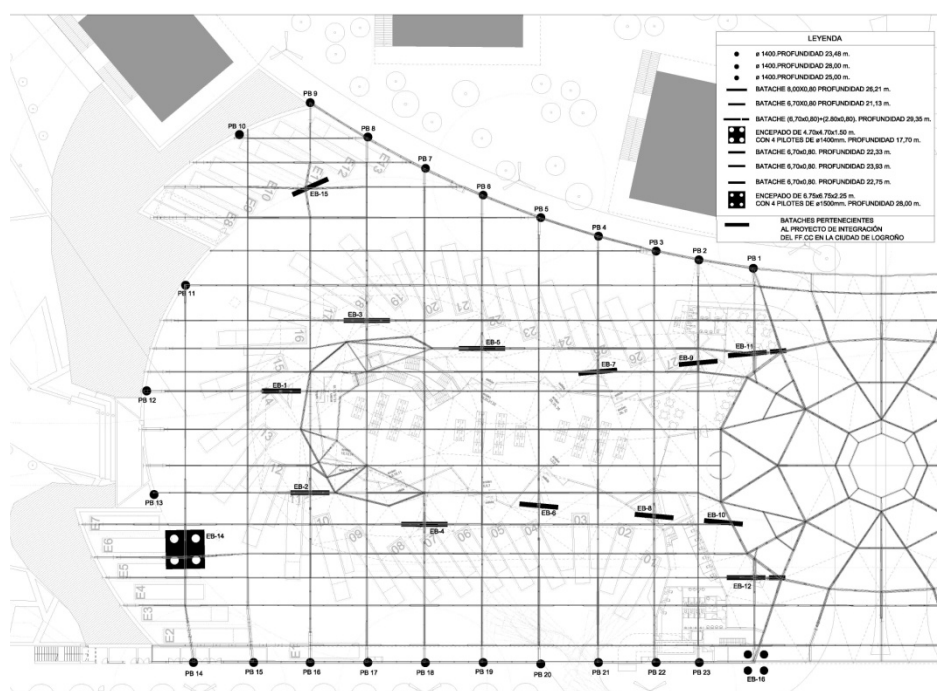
Planta estructural junto con las cimentaciones preexistentes.
